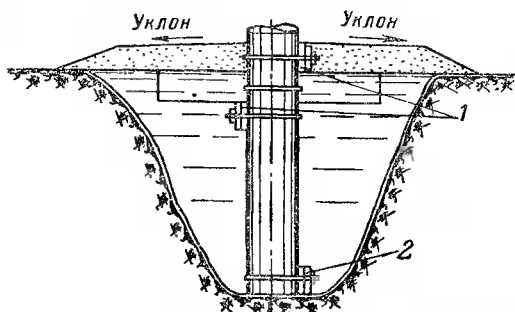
Нижняя часть железобетонной опоры с верхними и нижними ригелями.
